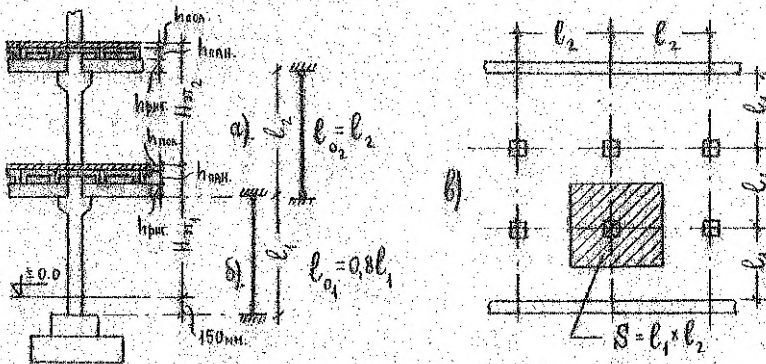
Определение расчетной длины колонны и грузовой площади колонны. а) колонны промежуточных этажей б) колонны нижнего этажа; в) грузовая площадь колонны.
